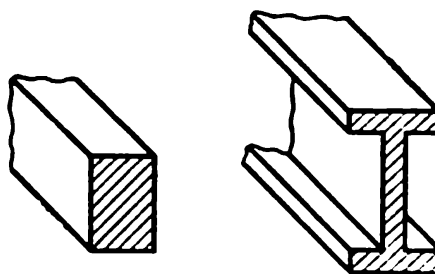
Des poutres de sections droites rectangulaire et en I.
